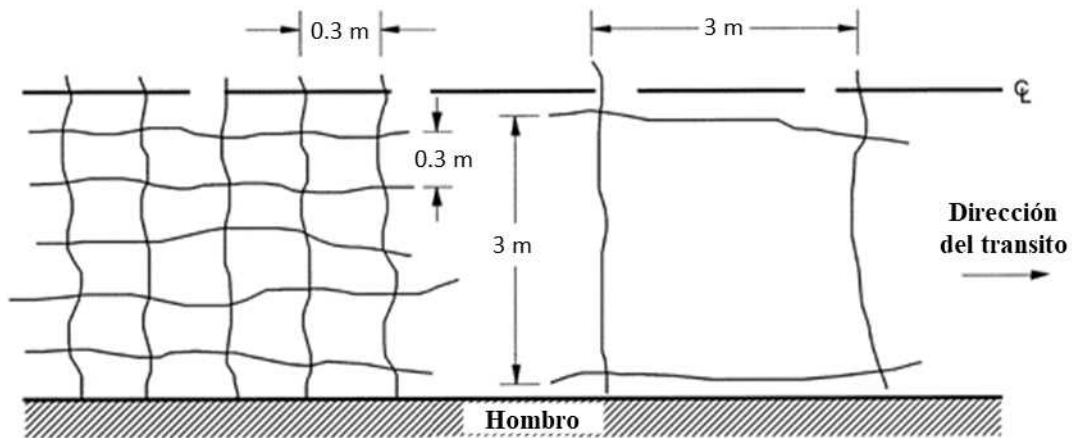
Dimensiones típicas de agrietamientos en bloque (Miller & Bellinger, 2014)
